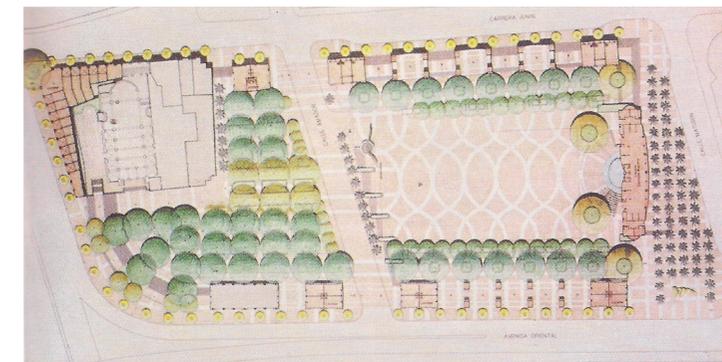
\_Parque San Antonio. Planta general. Revista Escala No. 169
